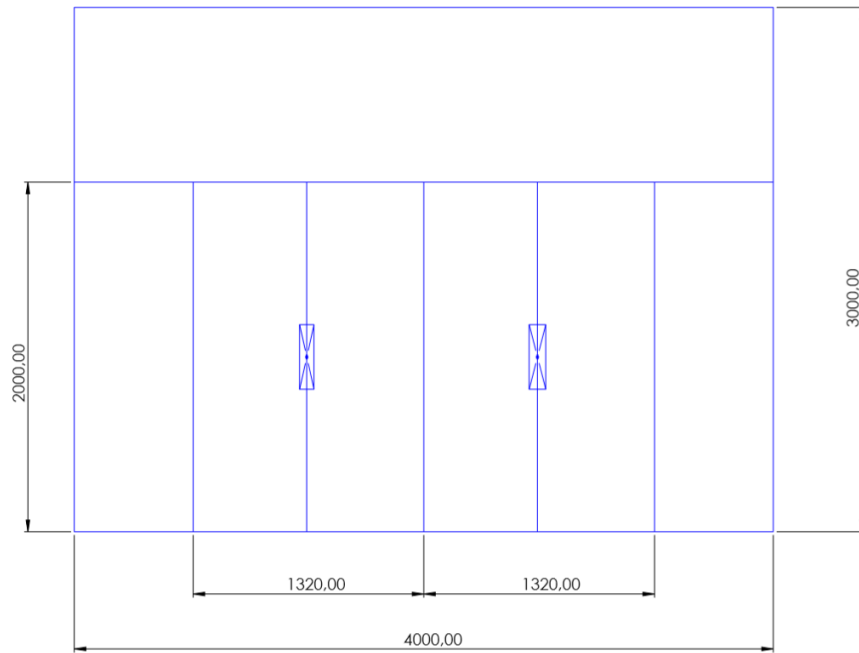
Vista frontal puertas de acceso a cámara de secado tipo, dimensiones en mm
